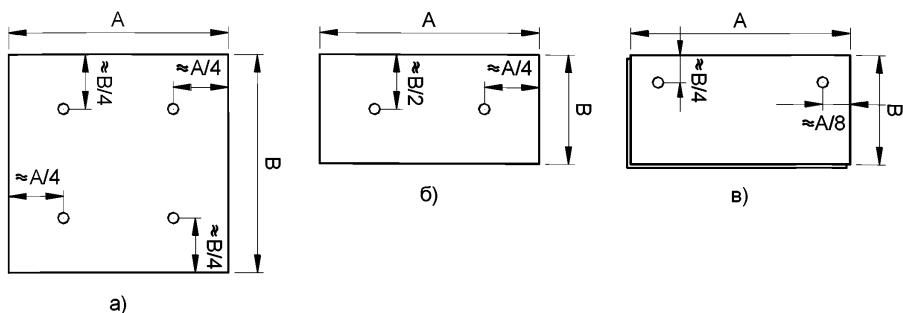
Схема крепления теплоизоляционных плит
